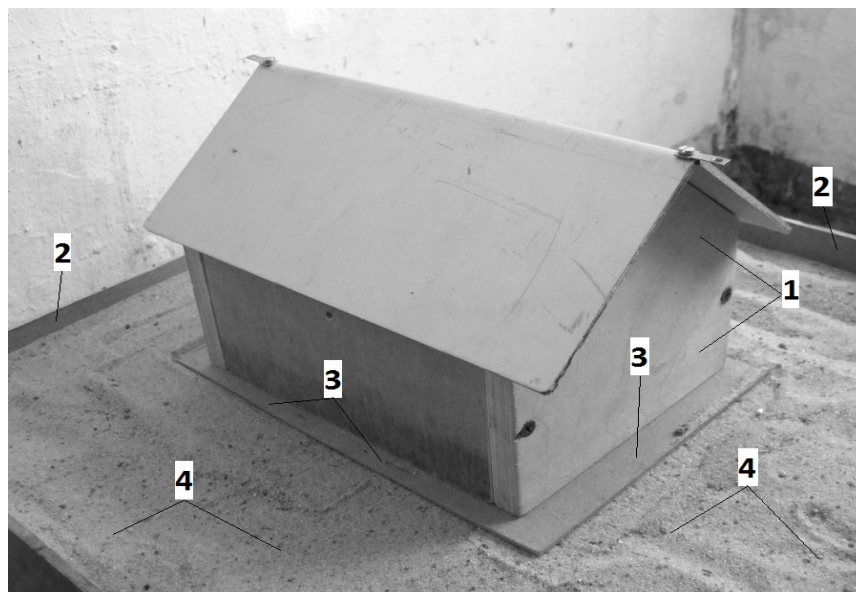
Схема випробувань: 1. – модель будівлі; 2 – ґрунтовий лоток; 3 – плитний фундамент; 4 – ґрунтова основа
